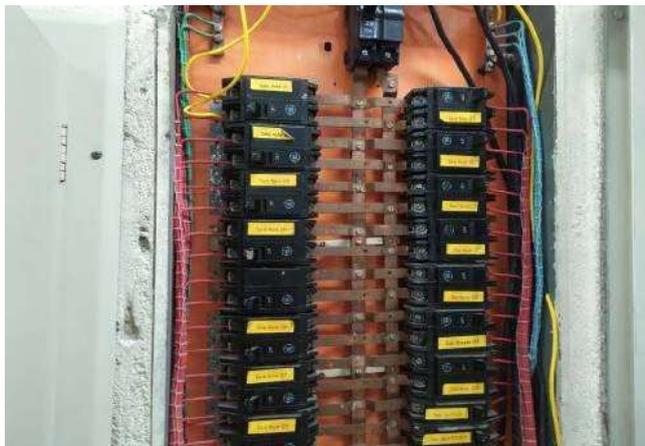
Corredor salas de aula pavimento superior 01, necessário revisão dos quadros elétricos.
